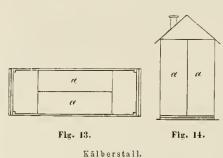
Grundriss. — Fig. 14. Ansicht des Stallpavillons von vorn.
